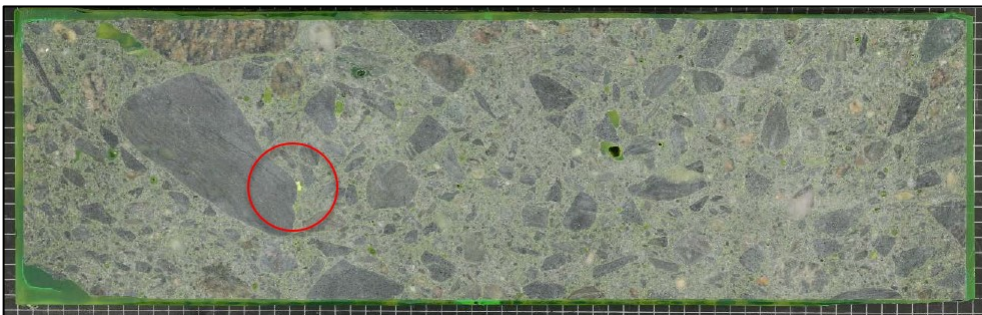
Planslip 0-300 mm (overflate mot venstre)
